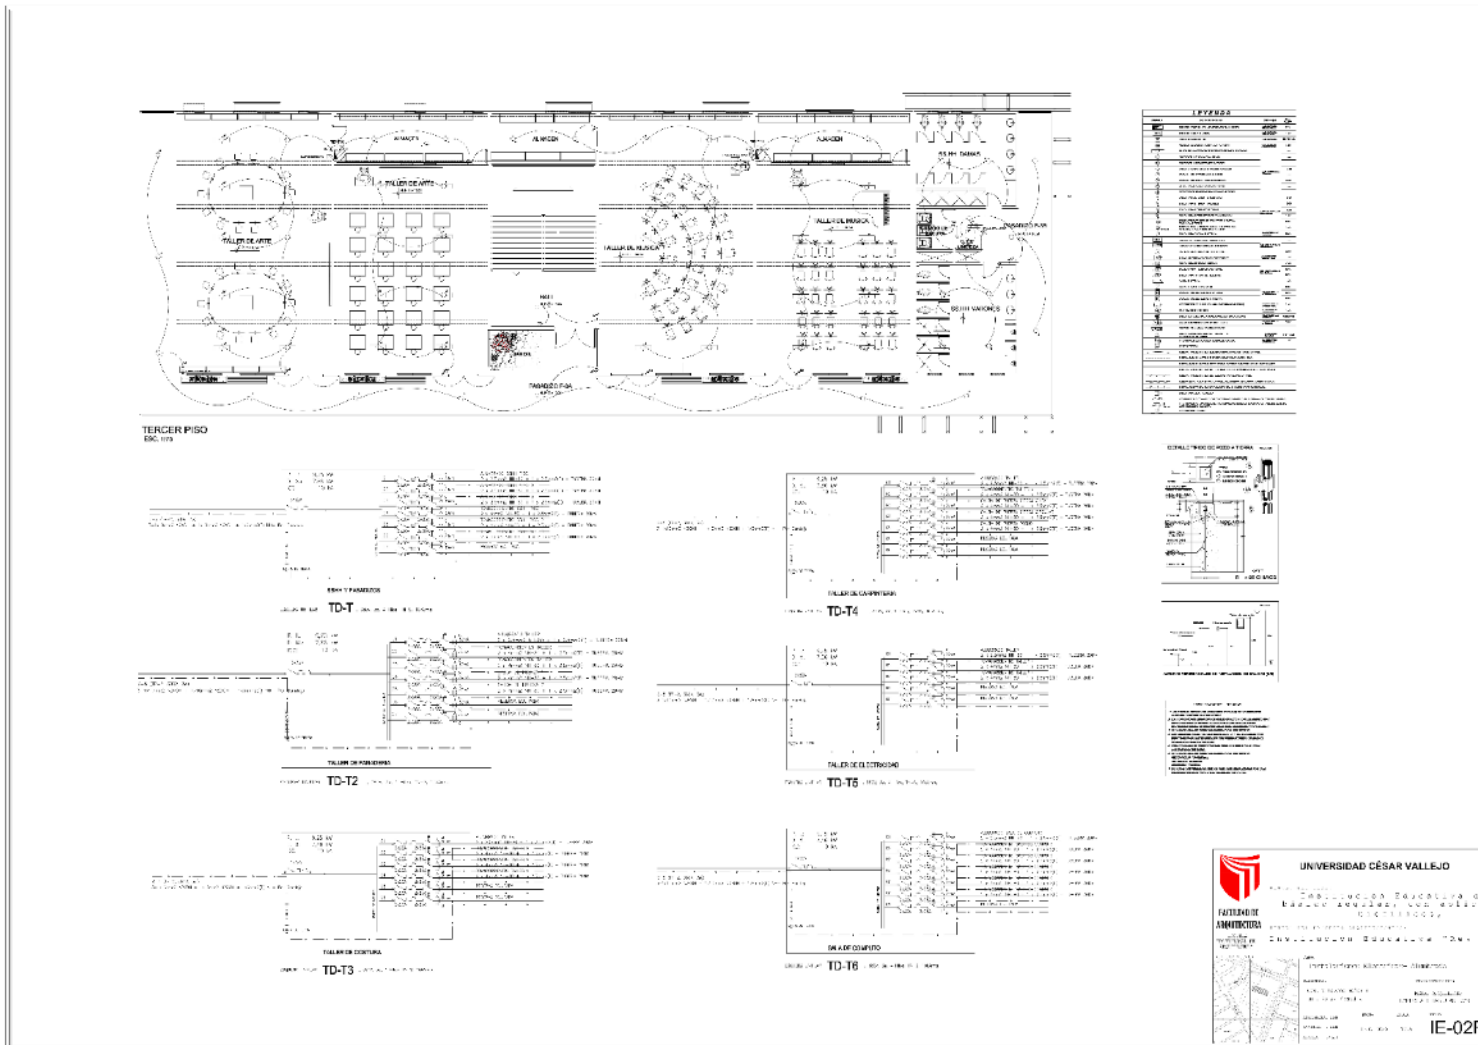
Plano alumbrado tercer nivel bloque "F", Fuente: elaboración propia
